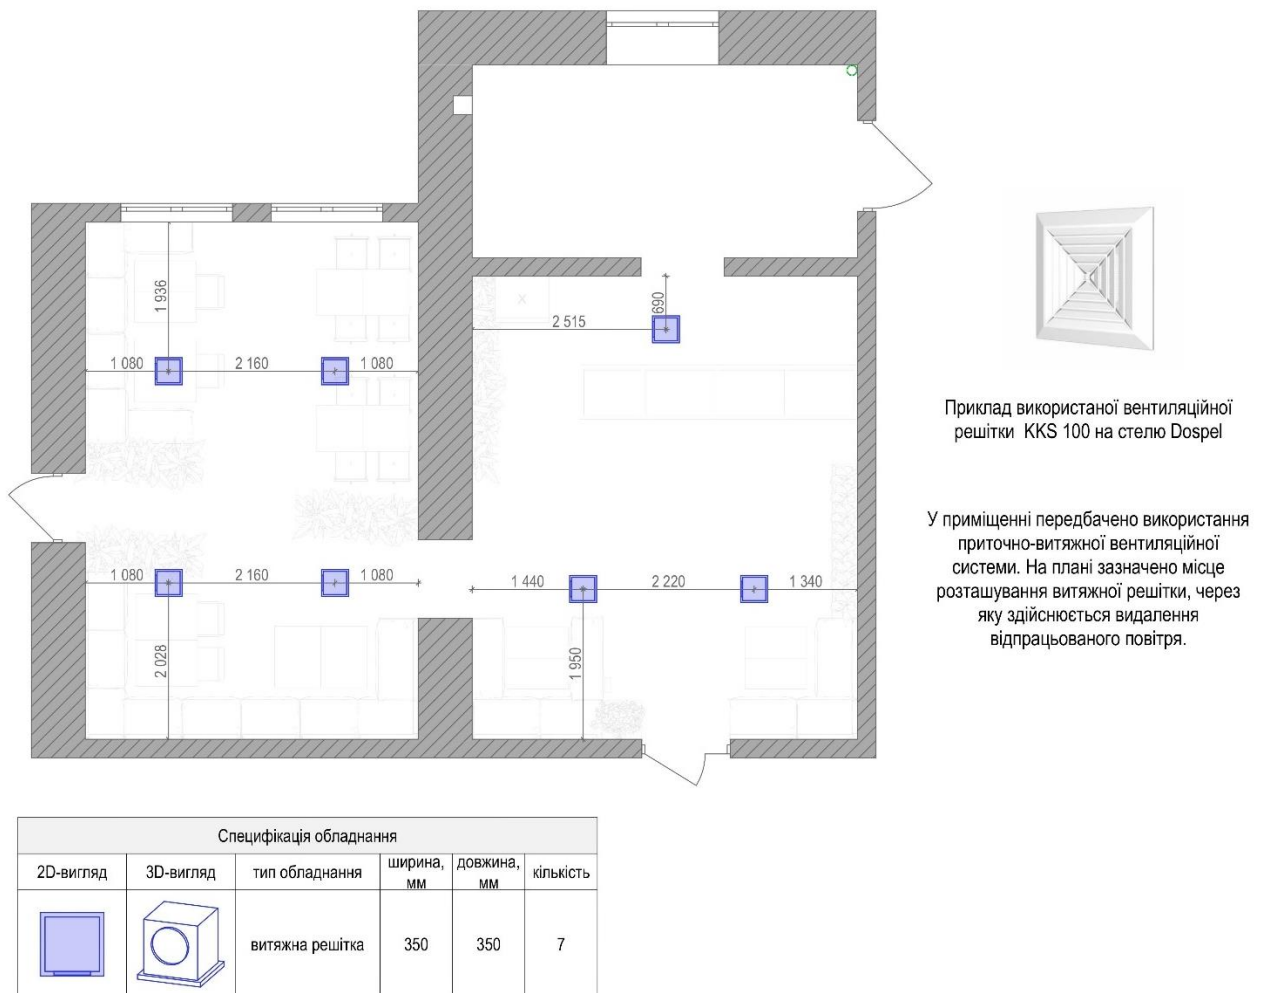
Схема плану вентиляції та кондиціонування
